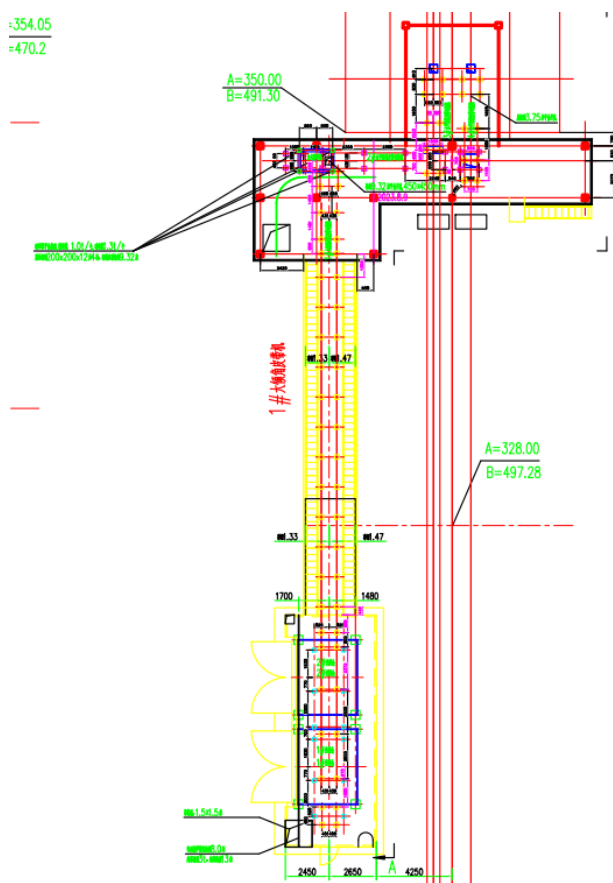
(b) 污泥掺烧局部平面布置示意图
